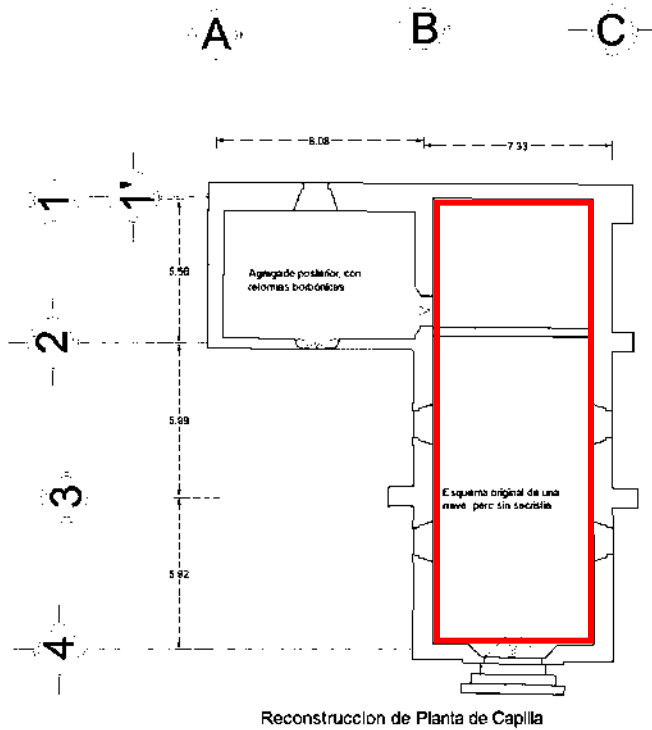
Plano de reconstrucción histórica de la capilla. Fuente: Plano elaborado por Enrique Ruíz Becerril.
